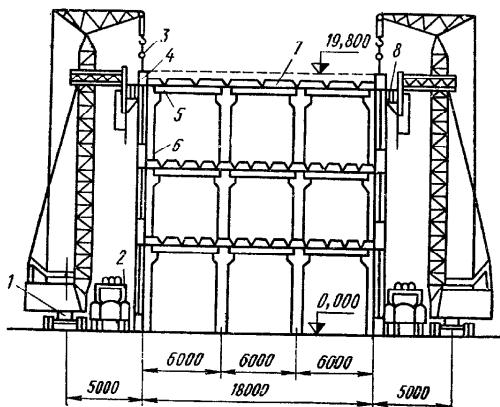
Монтаж стенного ограждения при помощи крана с башенно-стреловым оборудованием:
